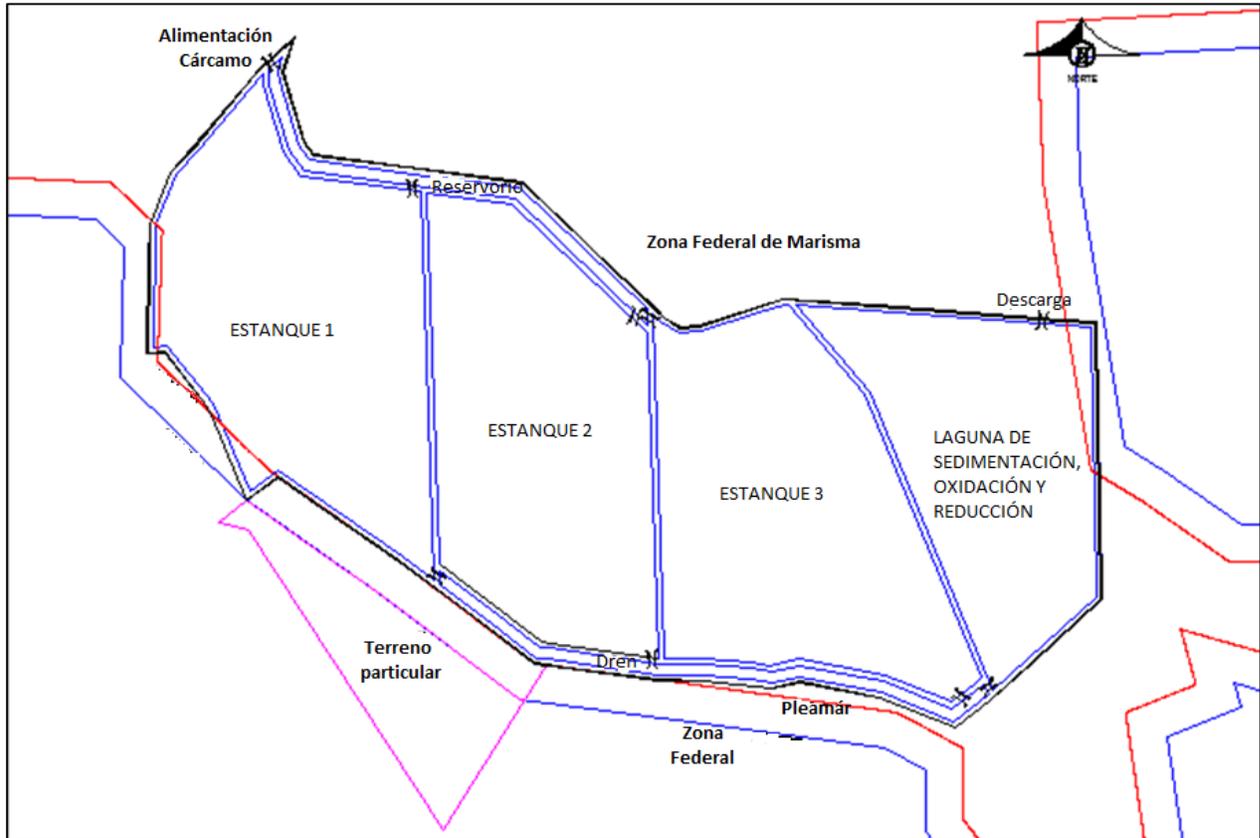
Plano de áreas del predio estudiado donde se denota la ubicación de la estanquería rústica, el reservorio y la laguna de sedimentación, oxidación y reducción.
